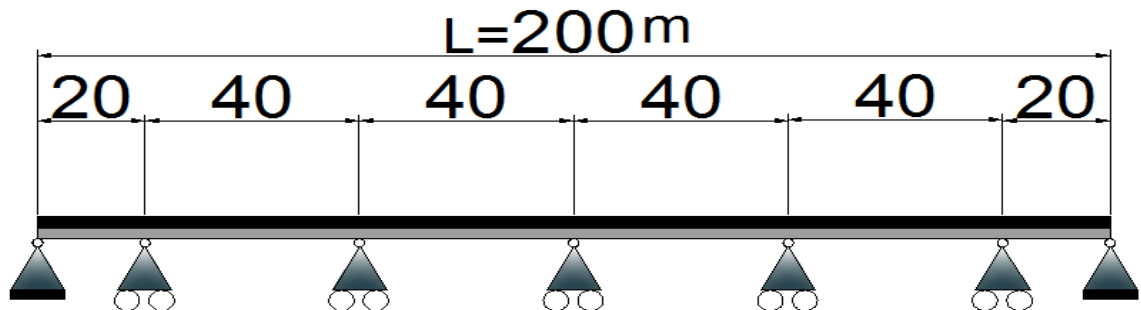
Schéma statique d'un pont à poutre en béton précontraint
